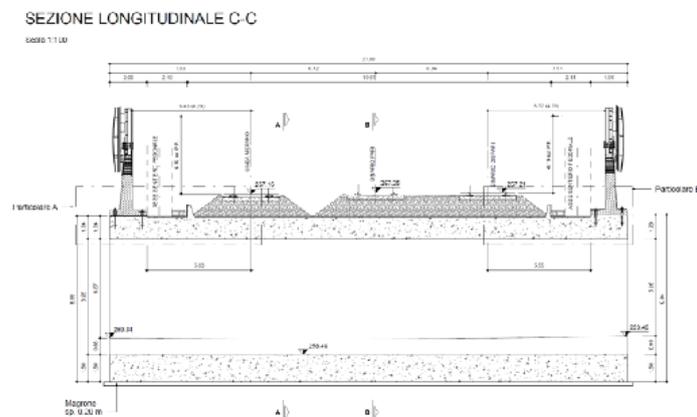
Sezione Longitudinale Opera di via Piè di Virgolo
